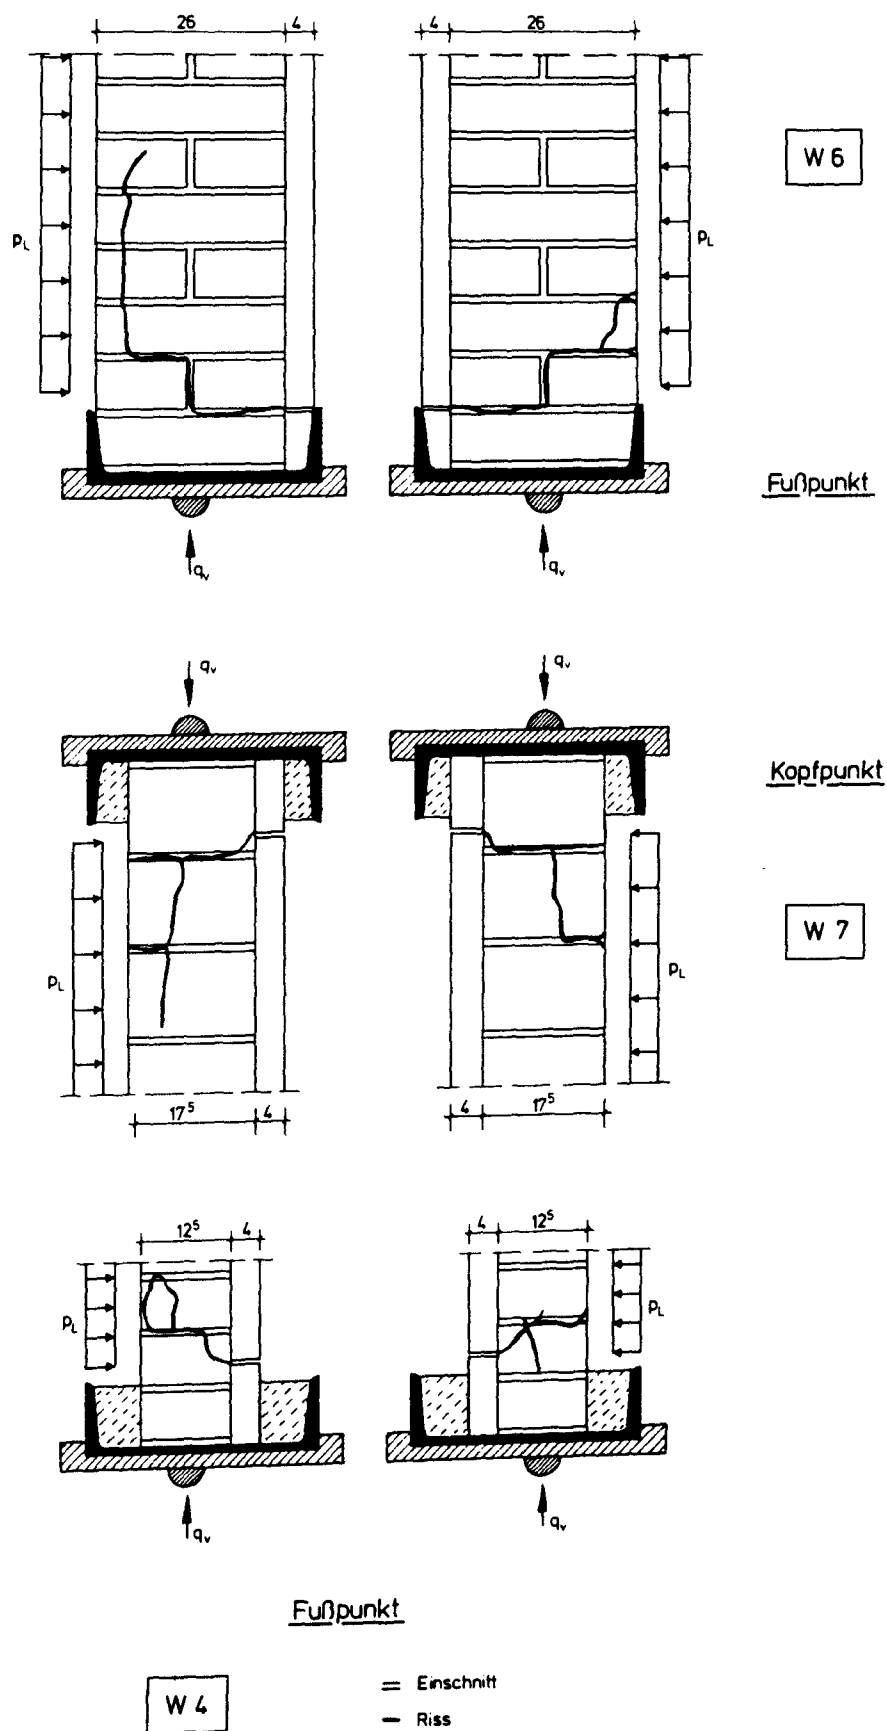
Schubrisse der Mauerwerkswände W4, W6 und W7
